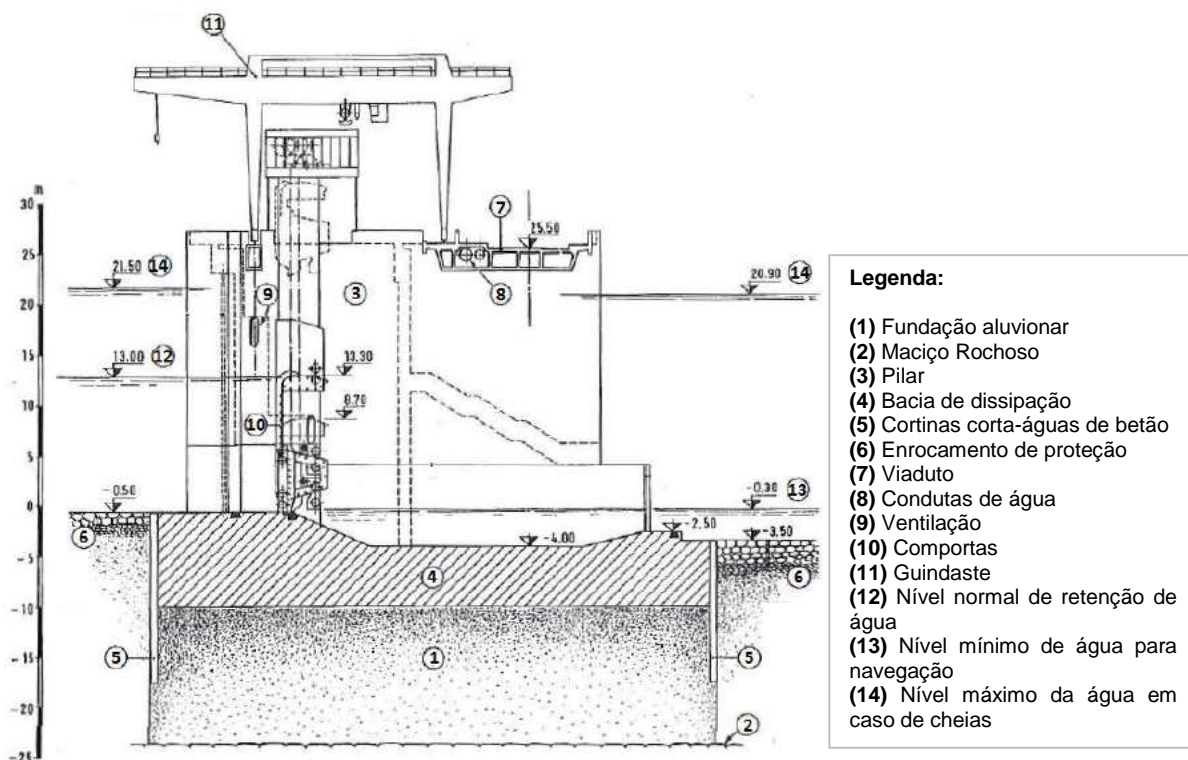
Perfil transversal da barragem de Crestuma-Lever [5].
